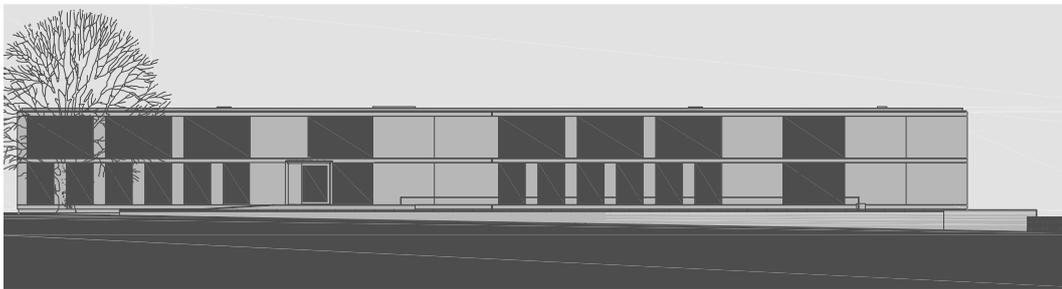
Alçado norte do centro de saúde de Vila do Conde
